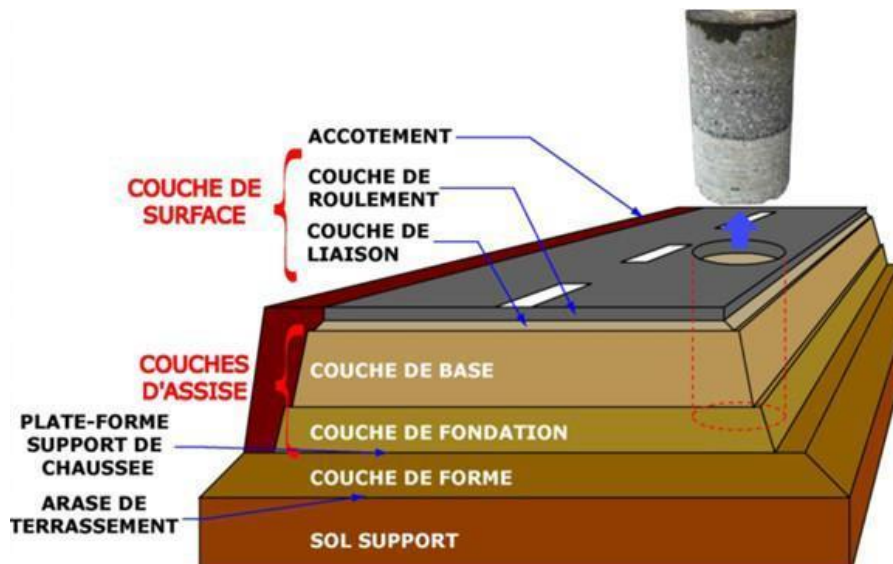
Constitution d'une structure de chaussée (TECHNIROUTE, 2009).
